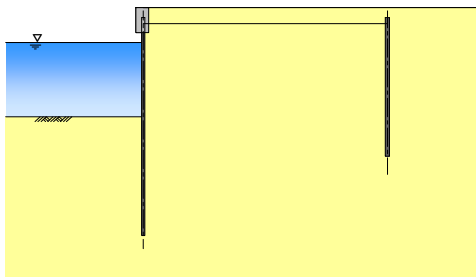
控え式矢板岸壁の断面図(施工前)
